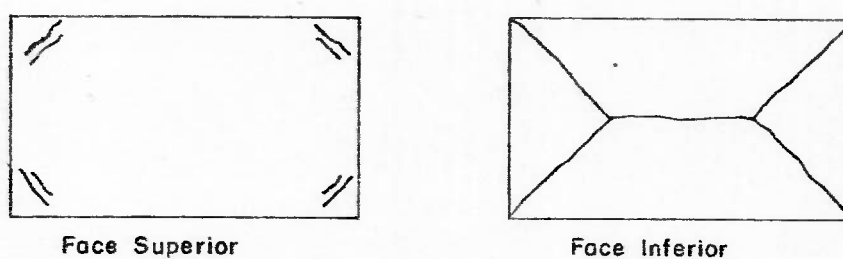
Fissuramento típico de lajes simplesmente apoiadas
